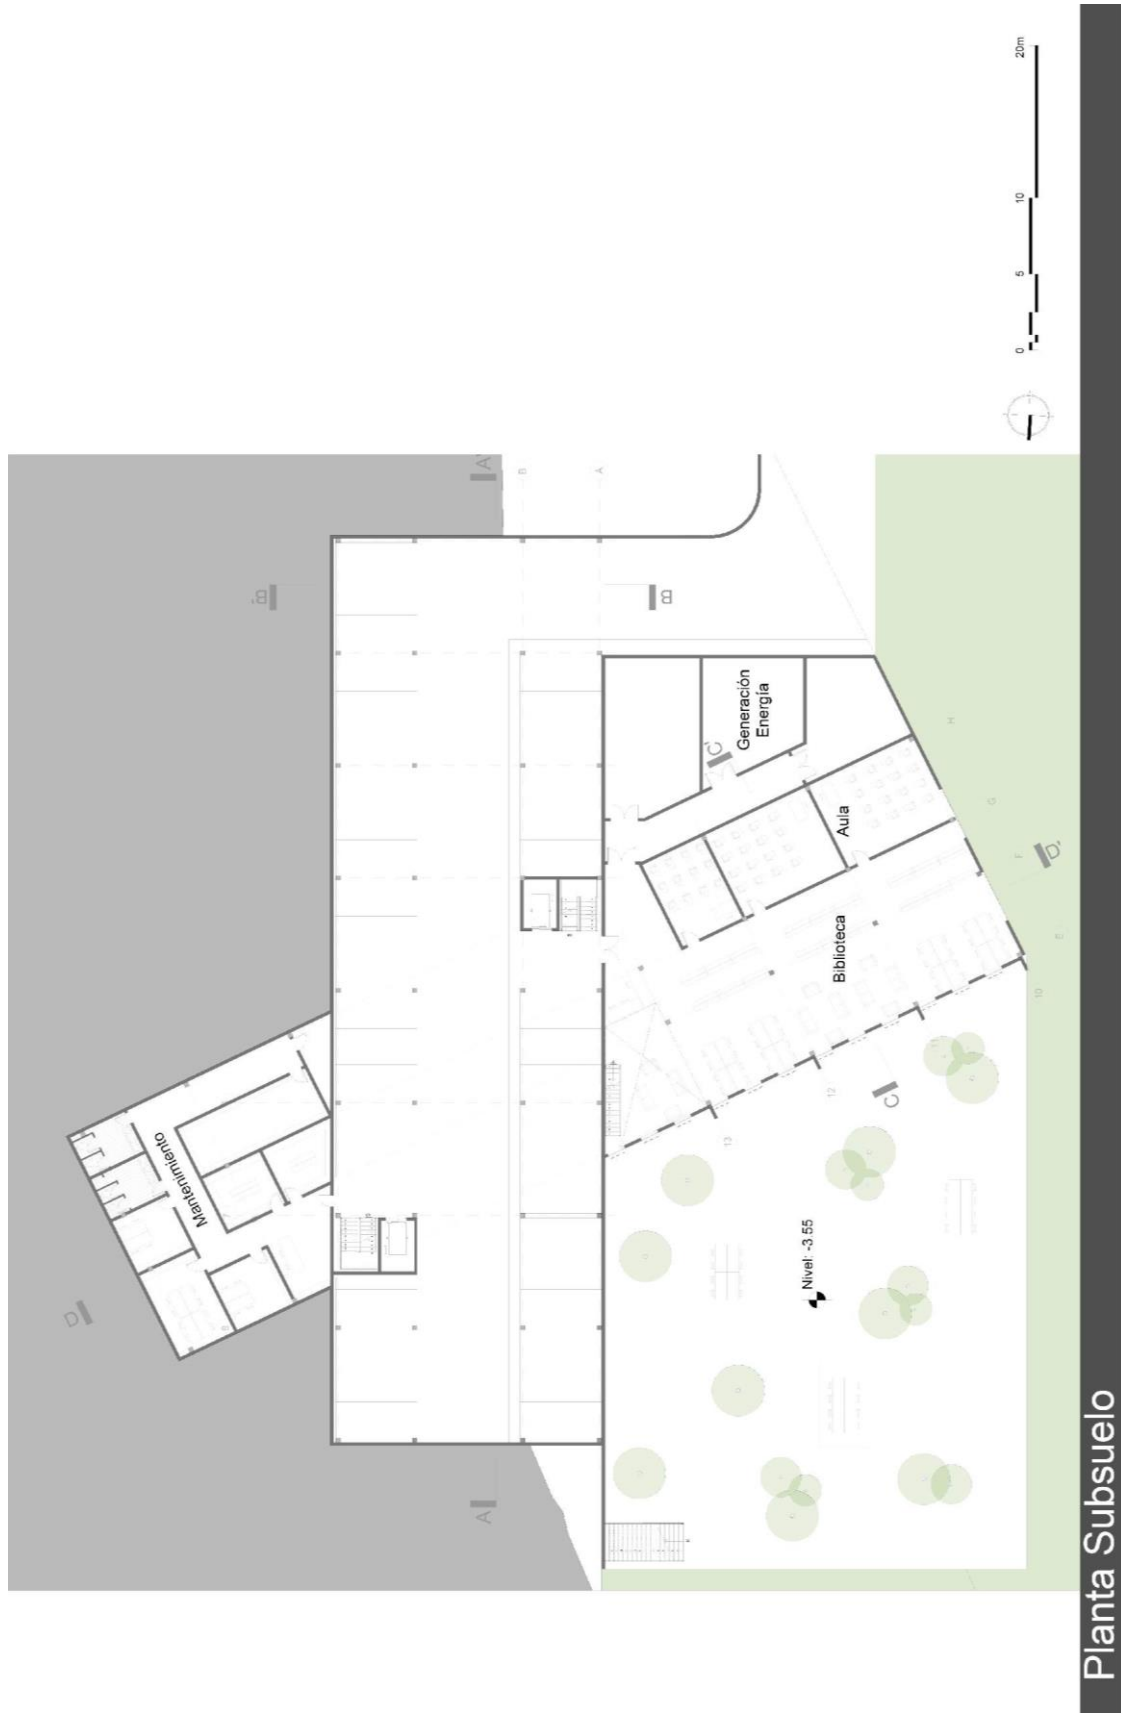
Planta Nivel Subsuelo. Elaboración Propia
